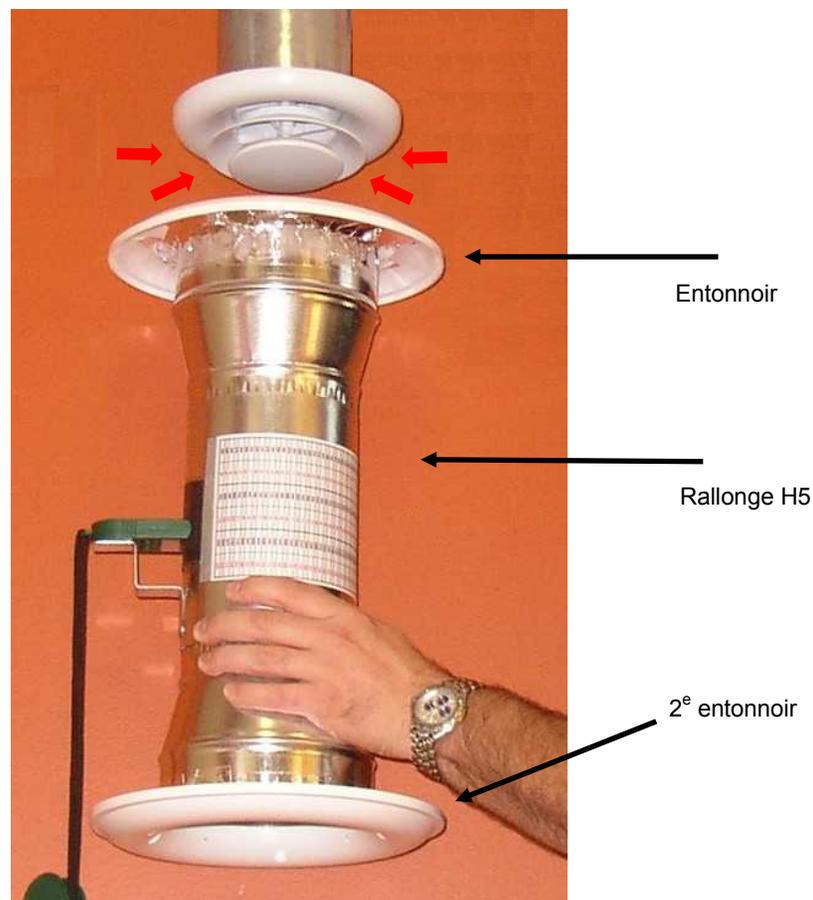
Dessins d'atelier – équipement de balancement (art.3.4.13.3)
